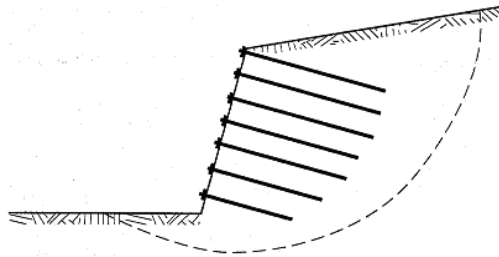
(sección de un muro de suelo clavado, y su falla típica)
